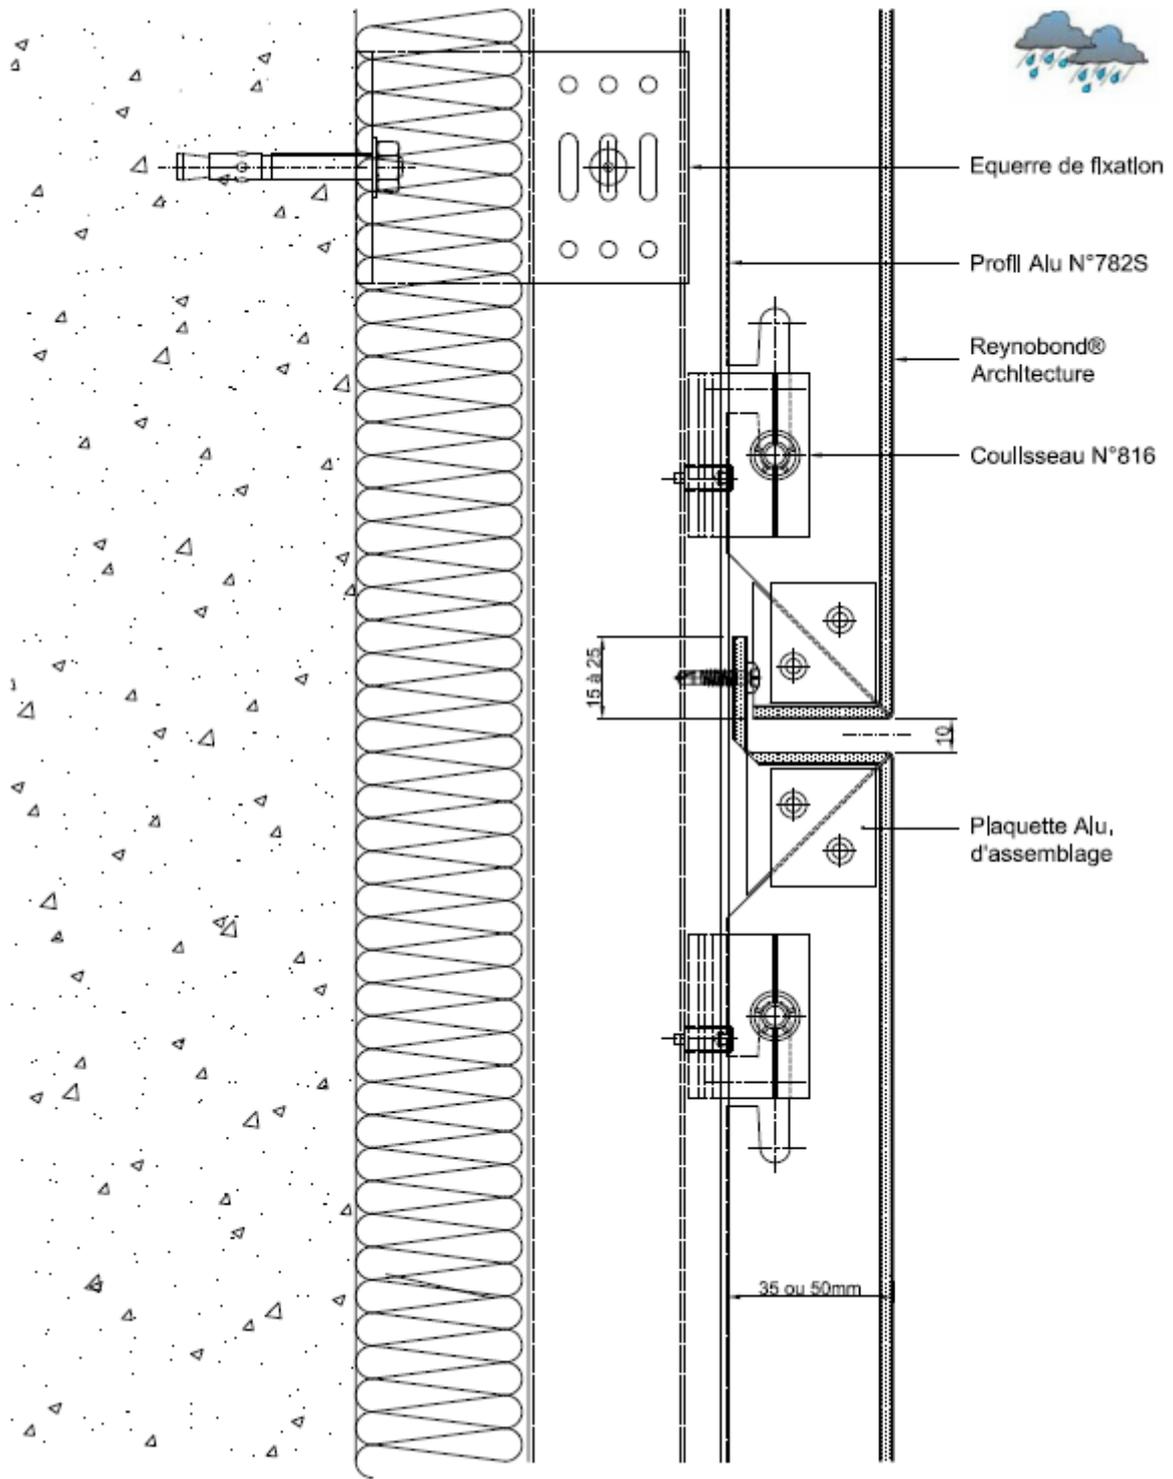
Coupe verticale Variante KU50 & 35 VA
